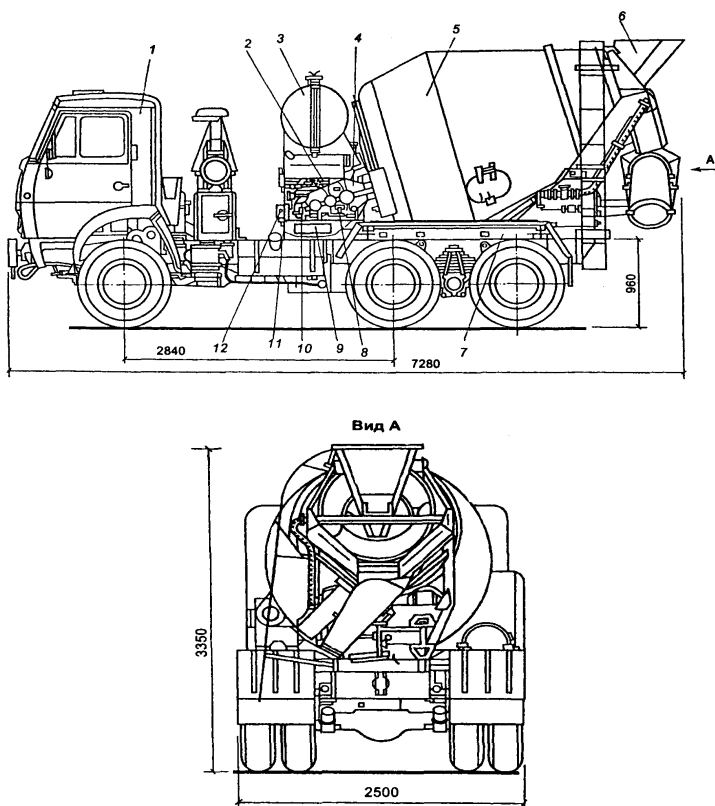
Автобетоносмеситель СБ-92-1А: 1 – автомобиль КамАЗ-5511; 2 – управление компрессором; 3 – бак для подачи воды; 4 – привод смесительного барабана; 5 – смесительный барабан; 6 – загрузочно-разгрузочное устройство; 7 – рама; 8 – управление реверсом редуктора; 9 – панель контрольно-измерительных приборов; 10 – муфта сцепления; 11 – муфта насоса; 12 – управление подачей топлива
